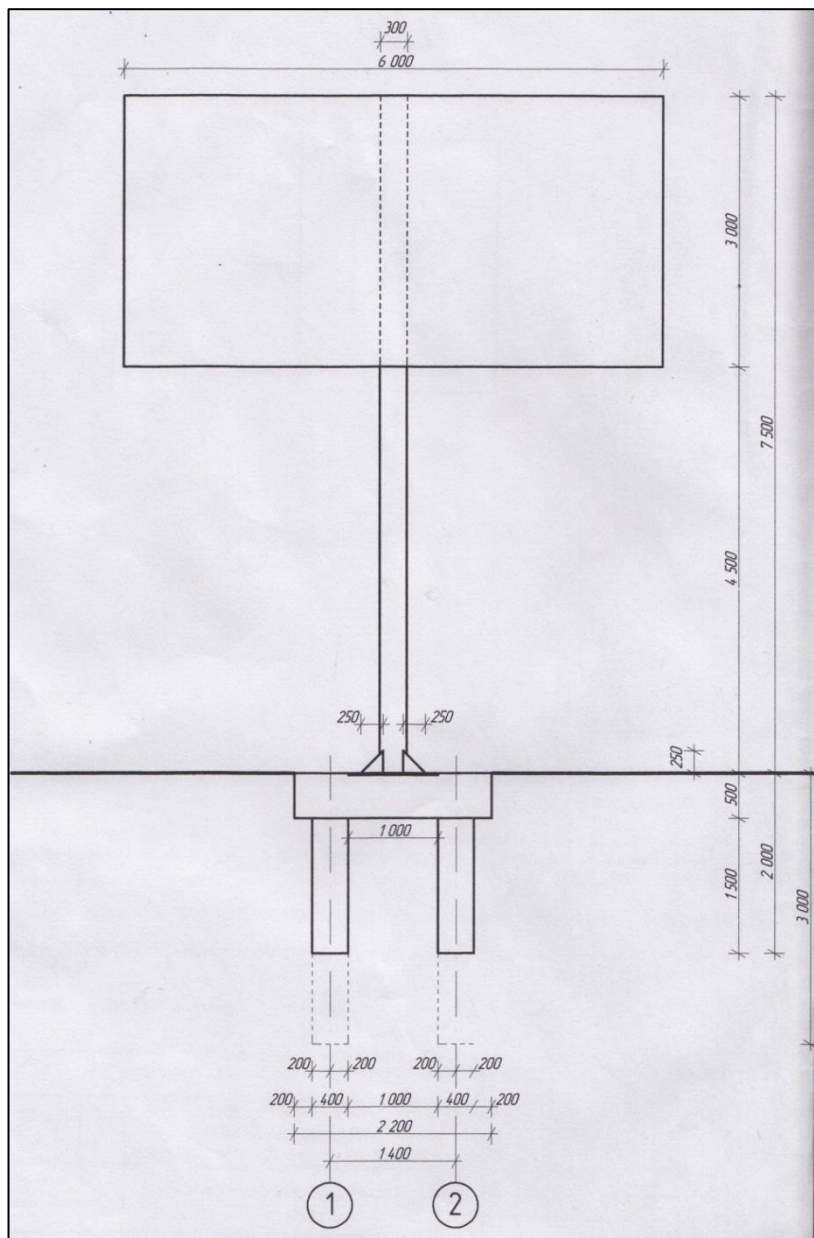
Вид и размеры рекламного щита (вид спереди)
